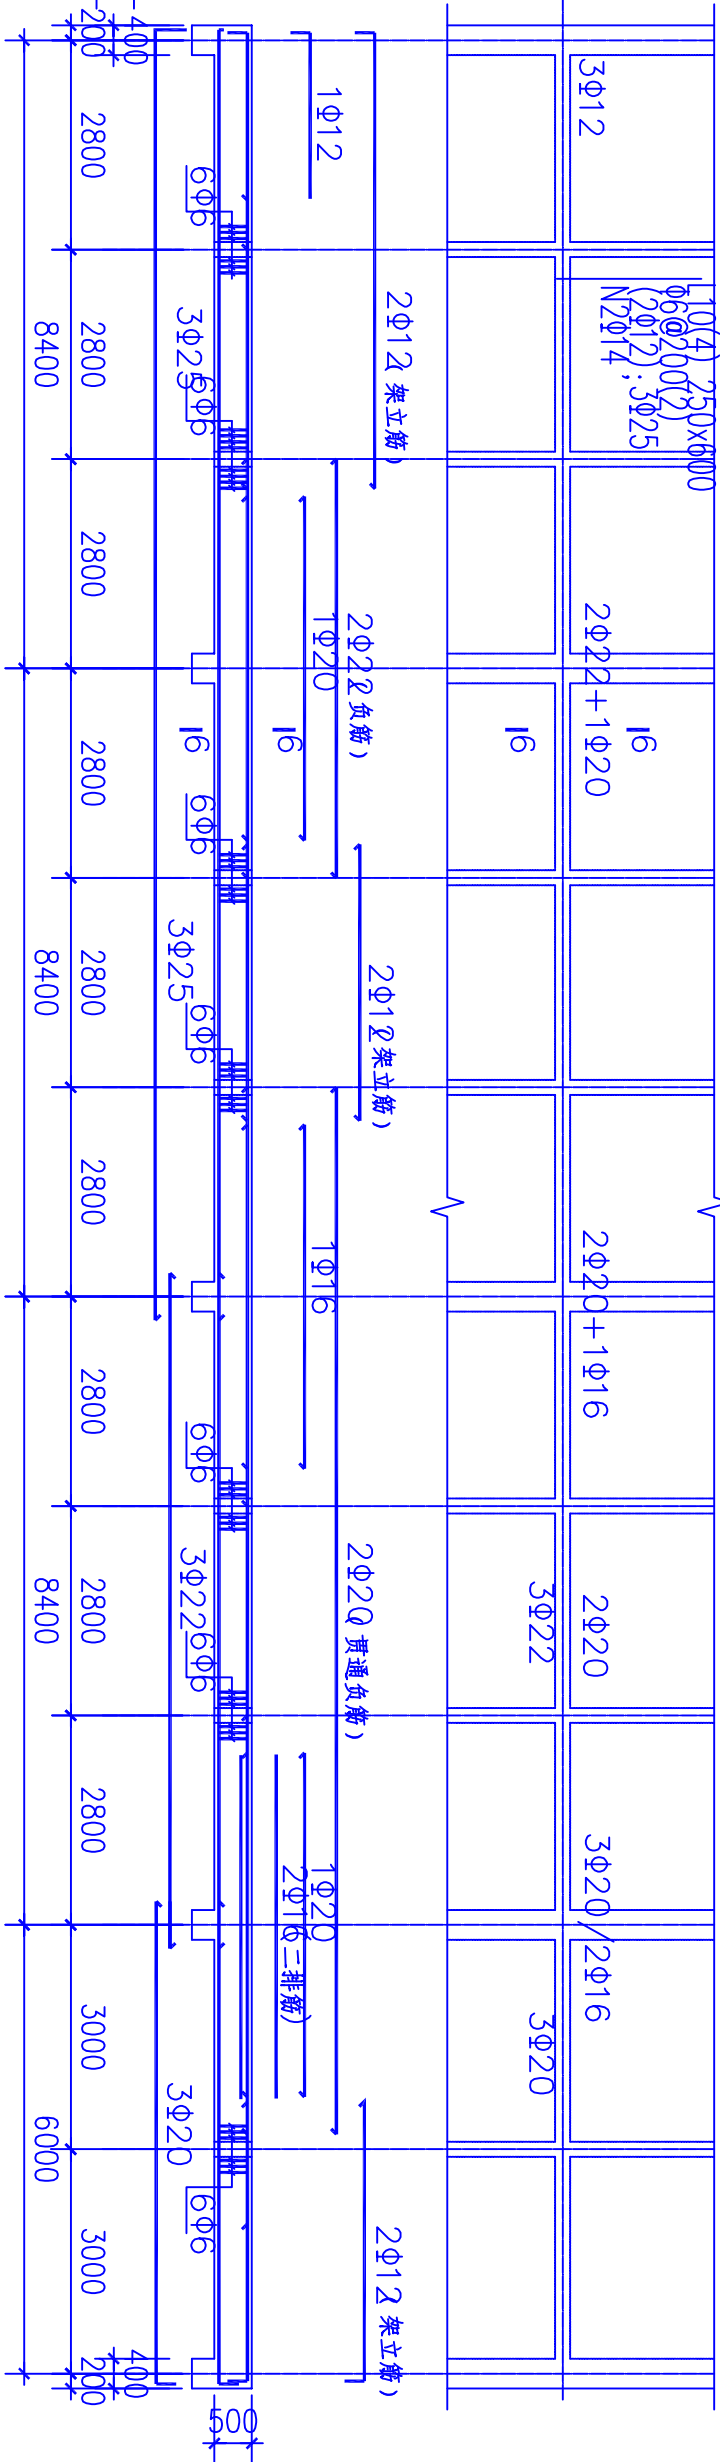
钢筋混凝土梁配筋平面表示法图例二 次梁做法示例：L10(4)
